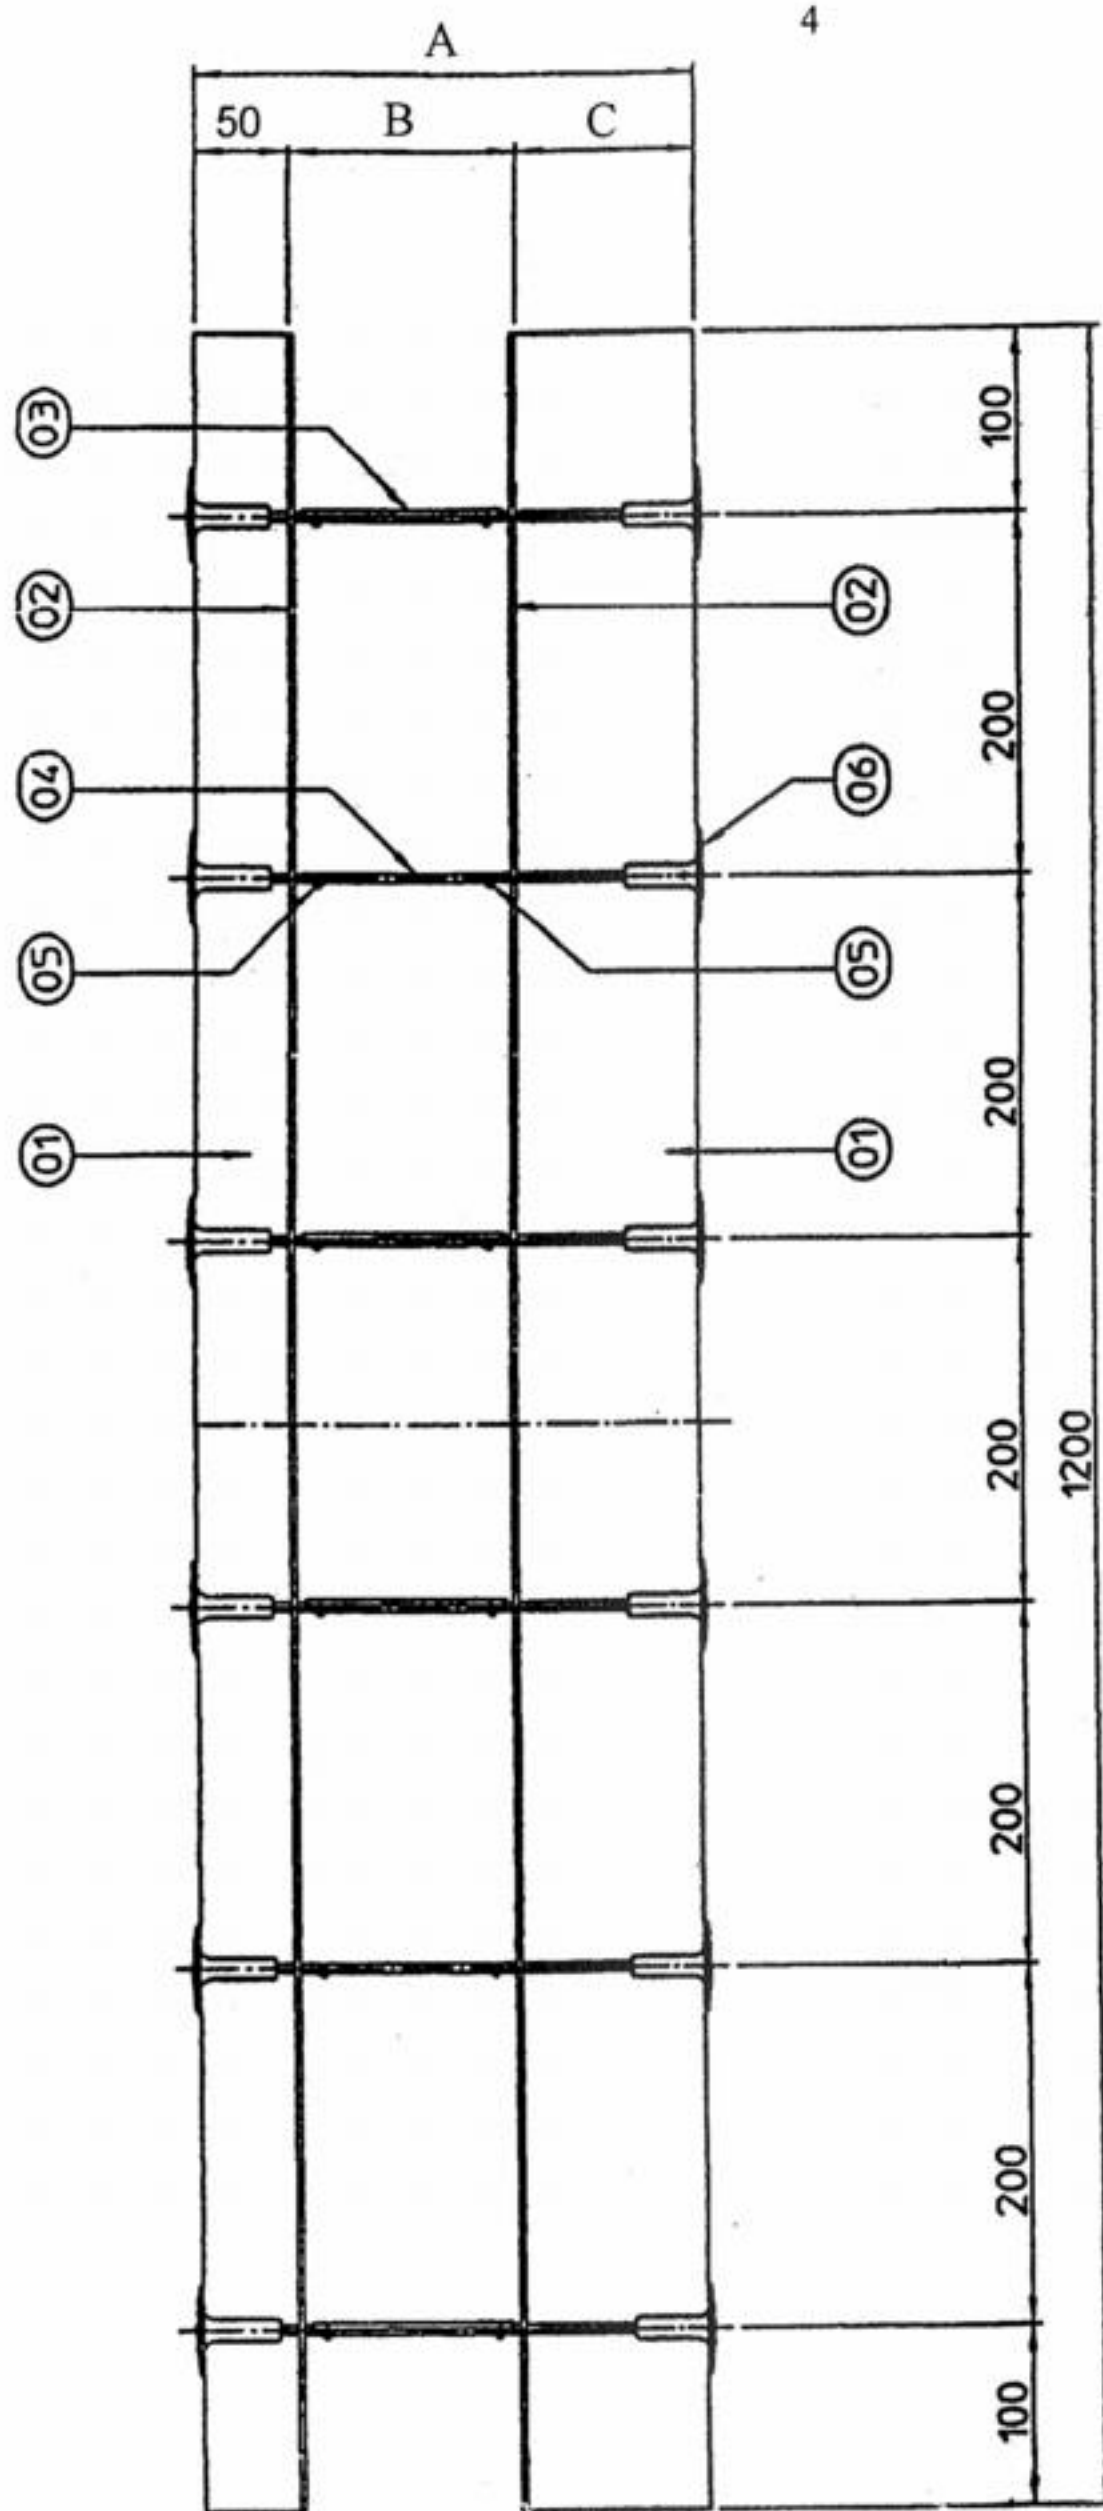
Рядовой элемент опалубочный наружной стены
